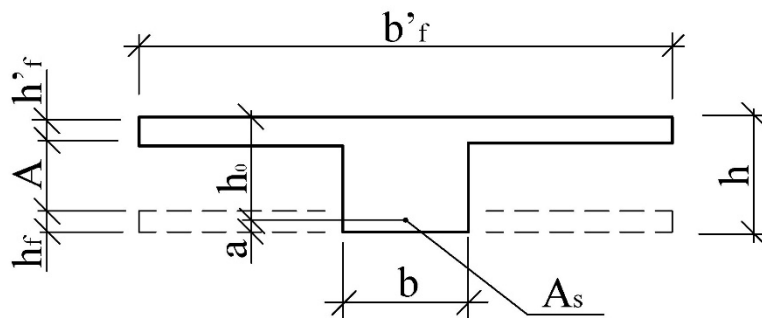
Фразмент узагальненого розрахункового перерізу залізобетонної плити перекриття
